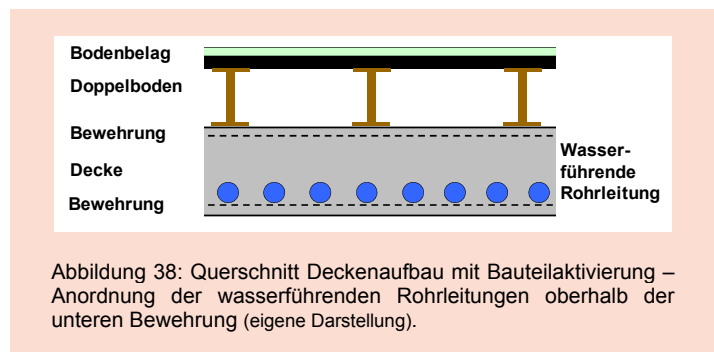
Querschnitt Deckenaufbau mit Bauteilaktivierung – Anordnung der wasserführenden Rohrleitungen oberhalb der unteren Bewehrung (eigene Darstellung).
